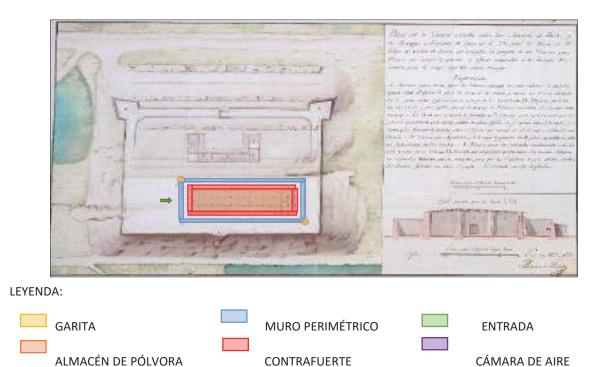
Plano de la guaca próximamente al fuerte de San Felipe donde se evidencia el proyecto de un almacén para pólvora. Fuente: Archivo de Indias
